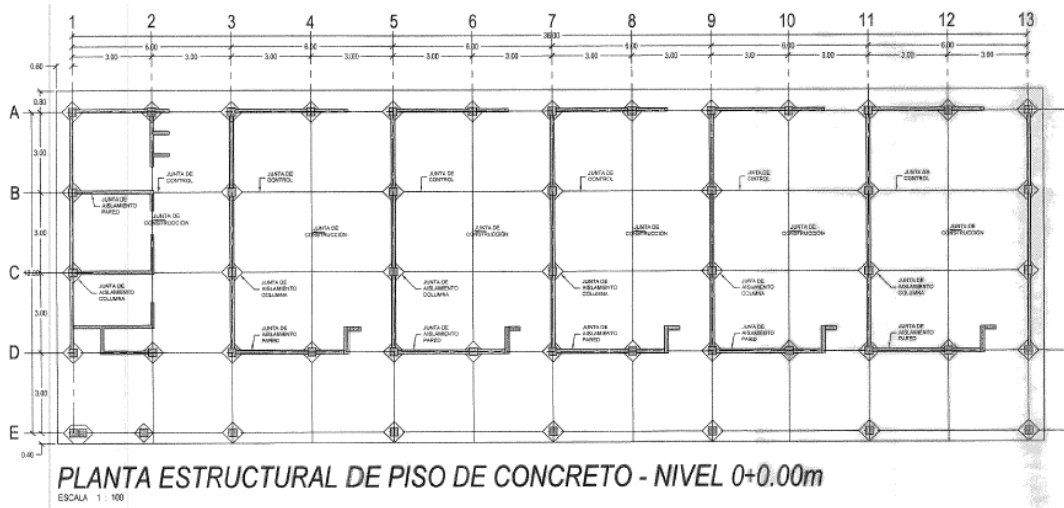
Vista en planta del primer nivel del edificio de aulas No.3 del CTP José María Zeledón Brenes, según planos constructivos
